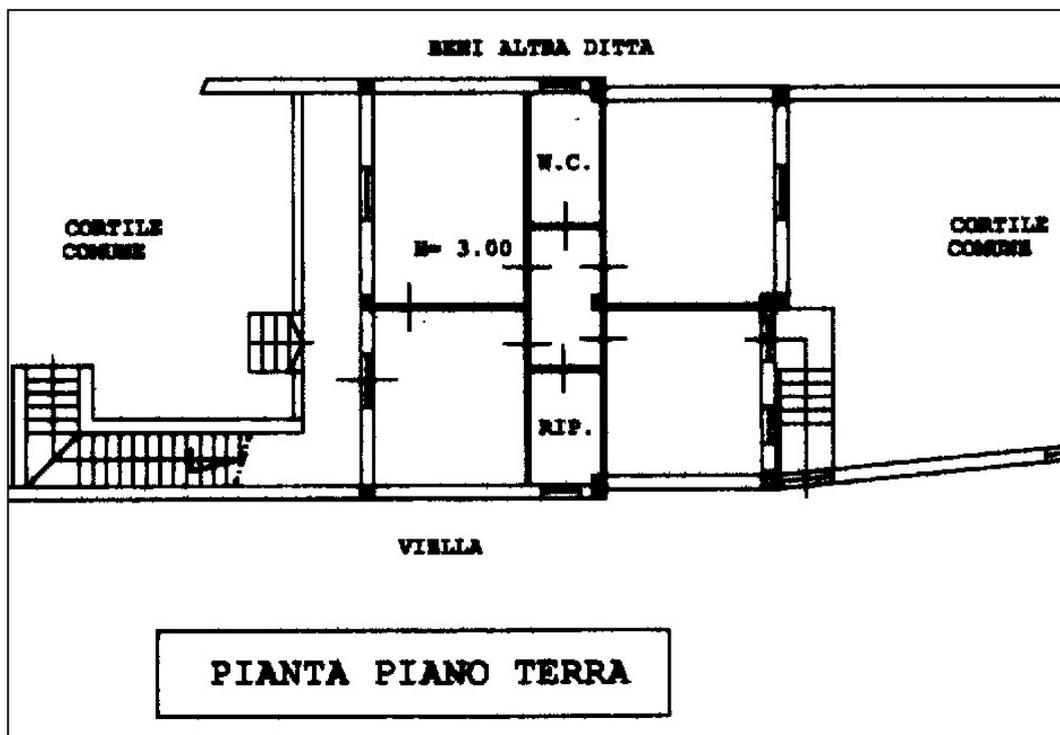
Planimetria in atti al catasto - appartamento (SUB 5) (alleg. 7)
